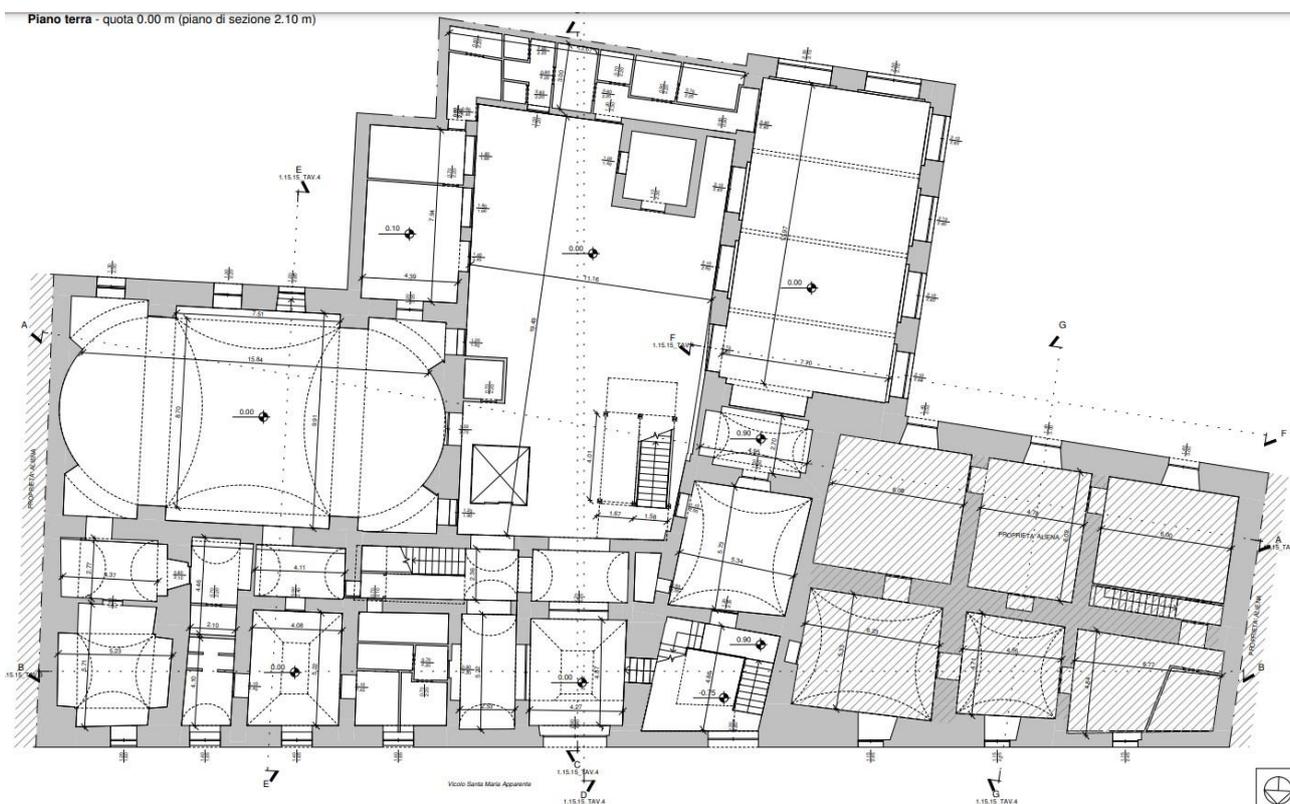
Pianta del Piano Terra dell'I.C. Baracca
